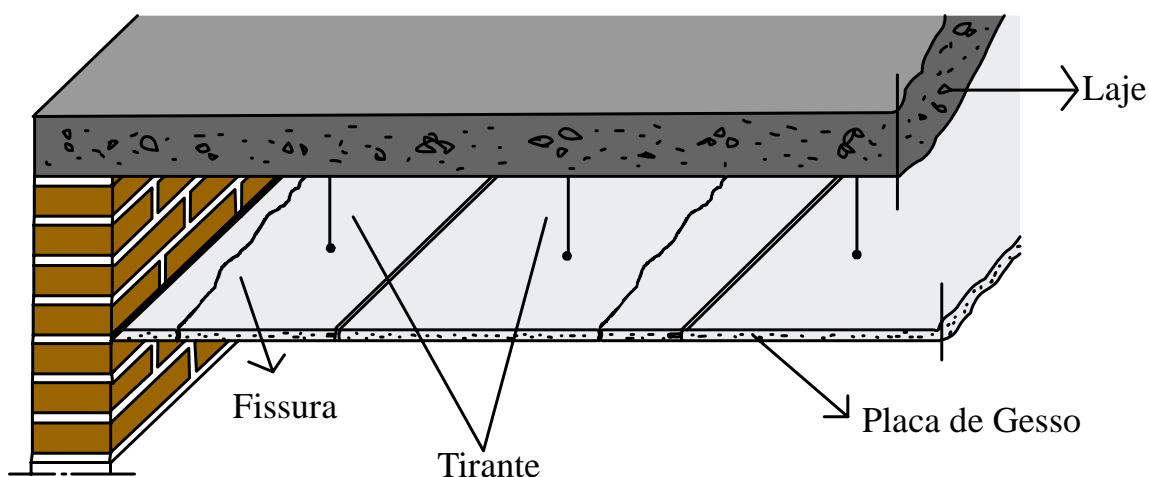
Fissuração de placas de gesso em forro rigidamente encunhado nas paredes –
